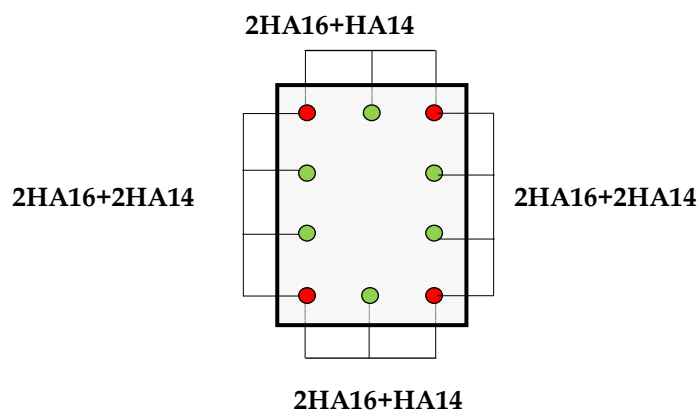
Disposition des armatures (PT 40x50)
